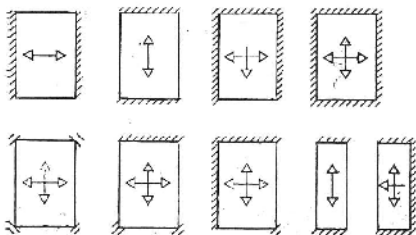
Схемы опирания сборных элементов перекрытий
